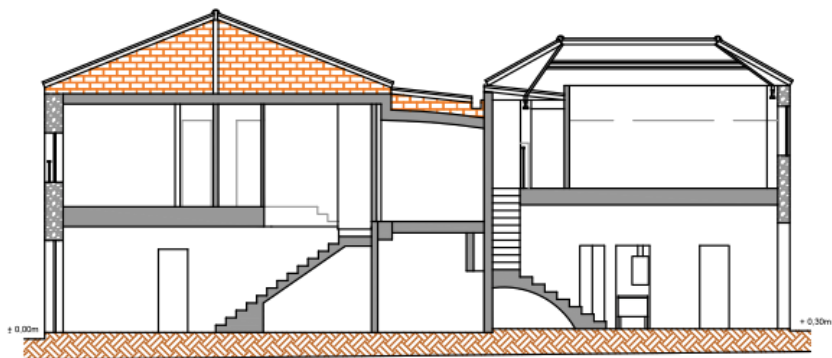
Sección principal de la vivienda por las escaleras. Fuente propia.
